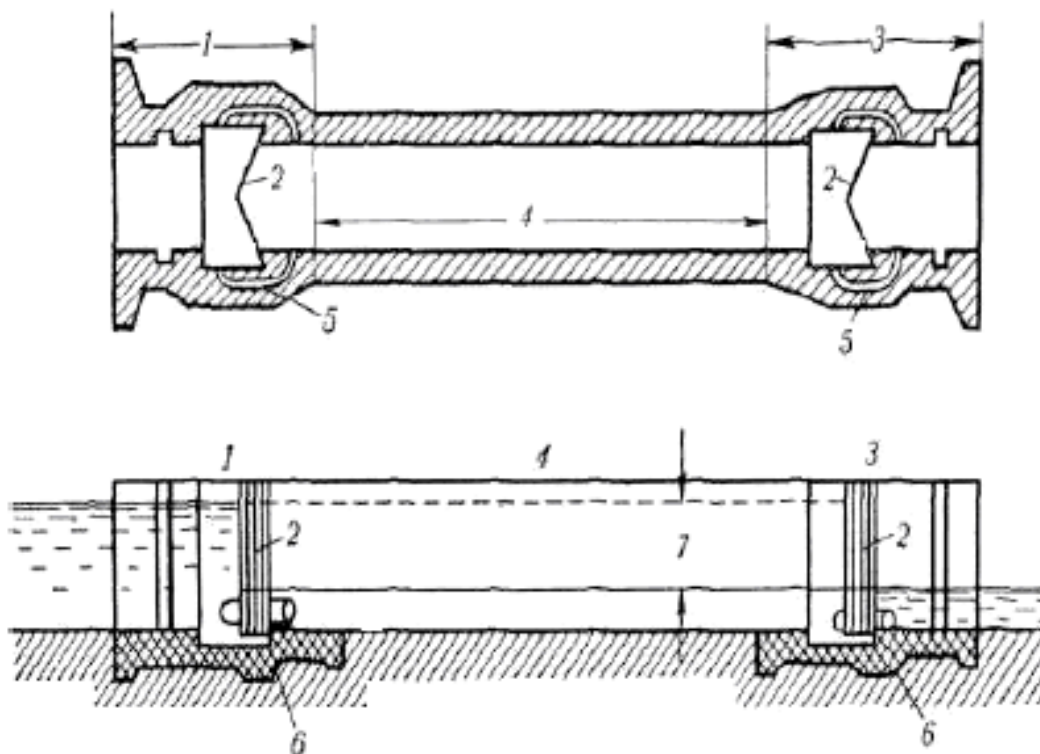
Конструкція судноплавного камерного шлюзу: 1 – верхня голова; 2 – ворота; 3 – нижня голова; 4 – камера; 5 – водопровідна галерея; 6 – поріг; 7 – натиск шлюзу
